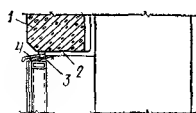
Крепление переплетов серии 1.436-4 к железобетонной колонне
